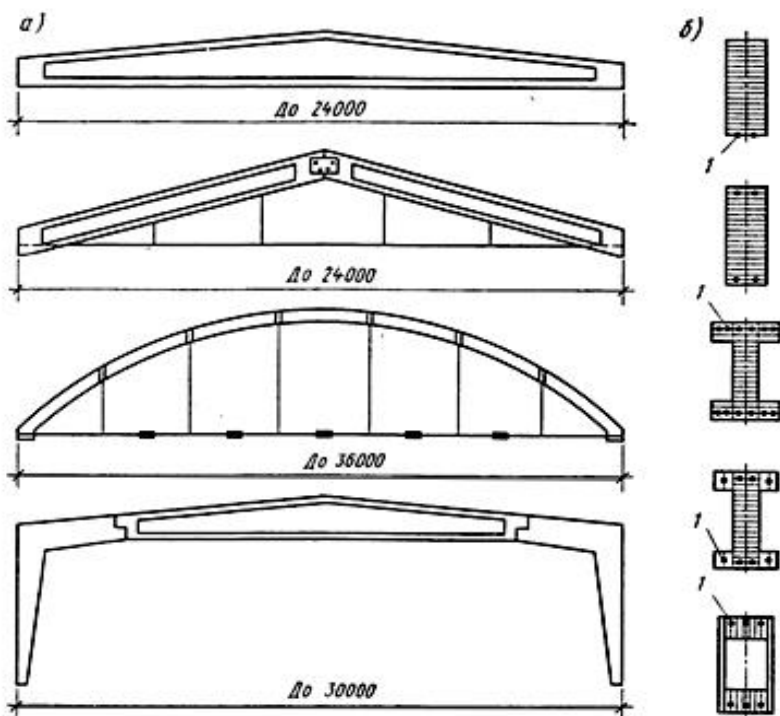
Армодеревянные клееные конструкции покрытия:
